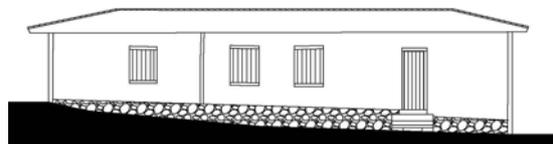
Fachada Direita (Acervo PROAU/FAU/UnB).
